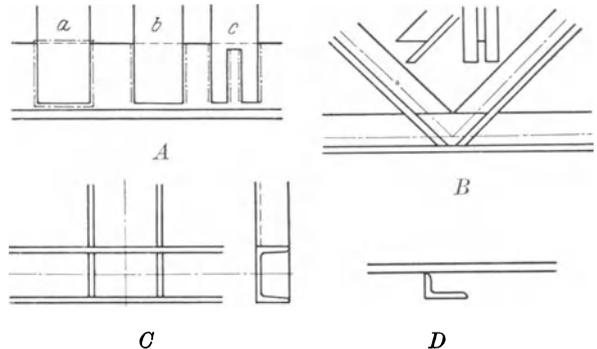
Schweißkonstruktionen. — · — · — Schweißnaht. A Flacheisenanschlüsse: a ringsherum geschweißt, b reine Flankennahte, c verstärkte Flankennahte. B T-Eisenanschluß, die beiden hochgehenden Eisen sind geschlitzt. C Eisenanschluß mit eingesetzten Blechen. D Verstärkung von Blechwänden.
